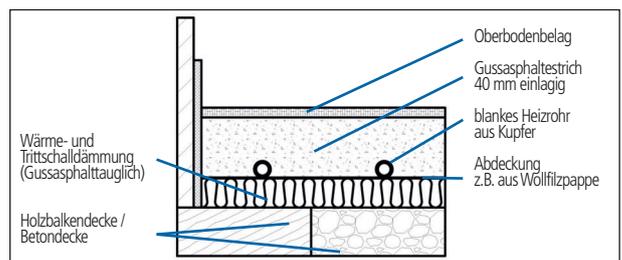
Bodenaufbau nach Bauart A mit Gussasphaltestrich
